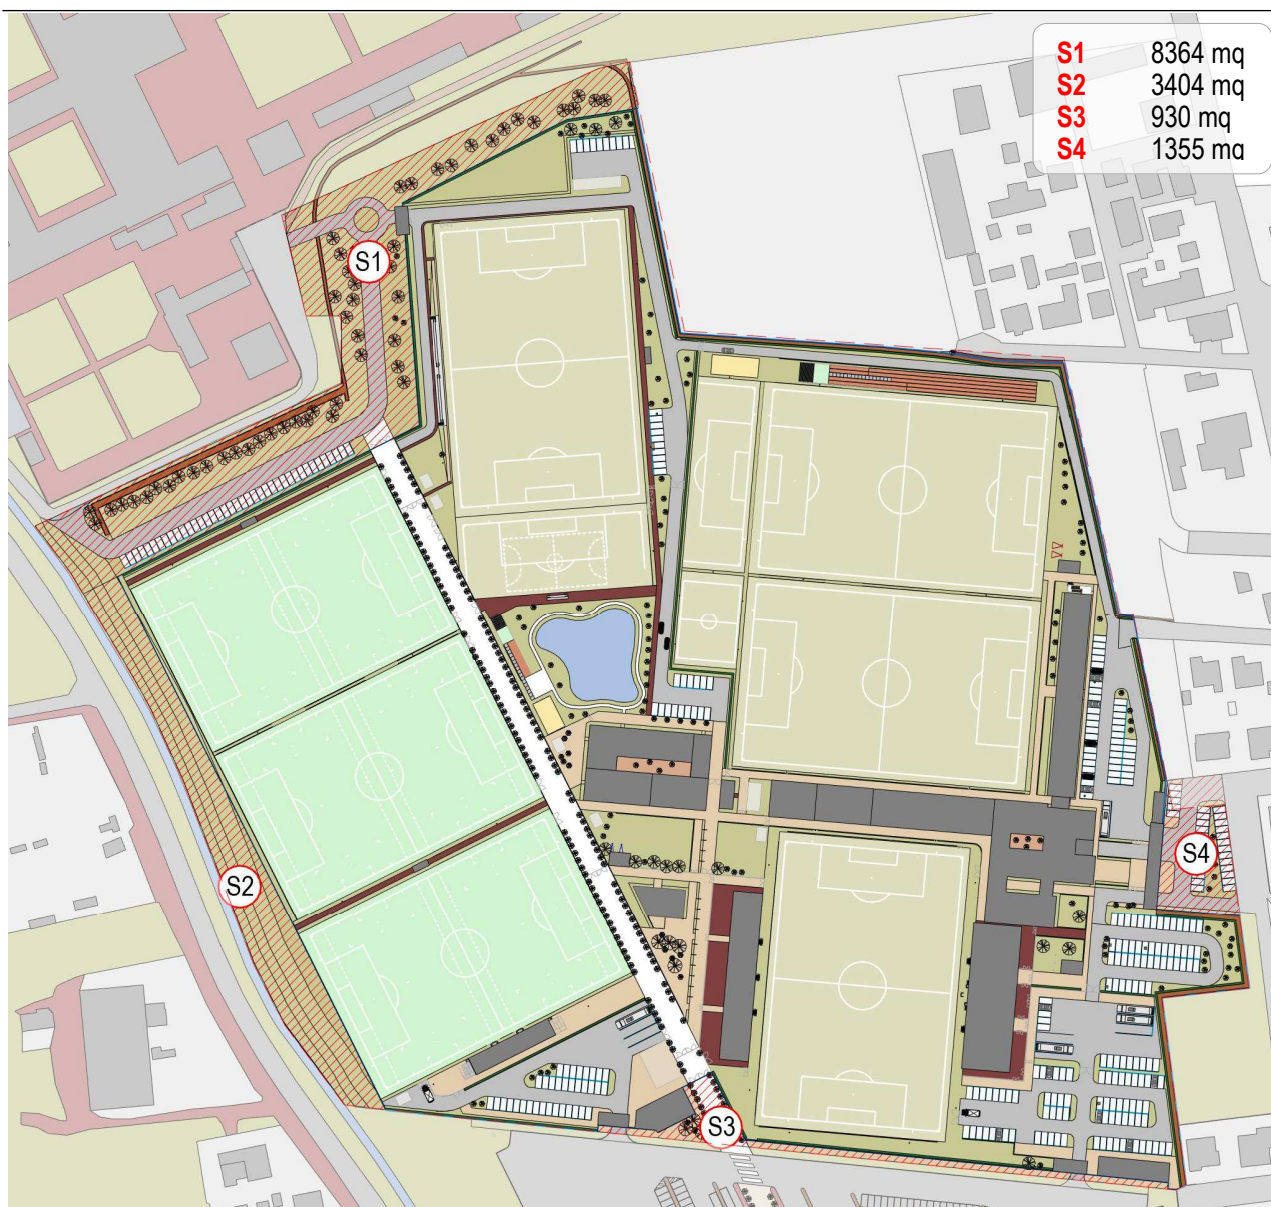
Planimetria di progetto con indicazione delle ipotetiche opere di urbanizzazione
